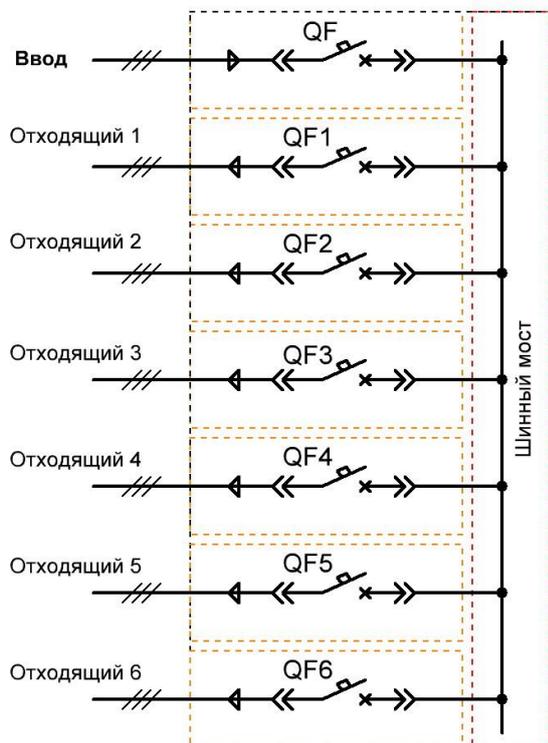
Схема однолинейная ШР-ПП-100...1600А с выдвигаемыми автоматическими выключателями.
